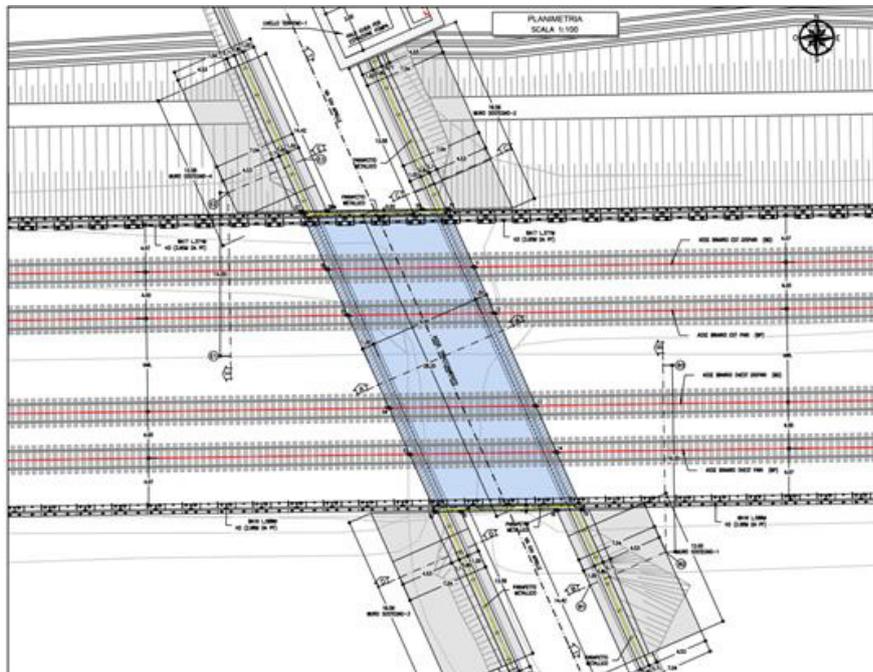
SL06 – Stralcio planimetrico sottopasso
